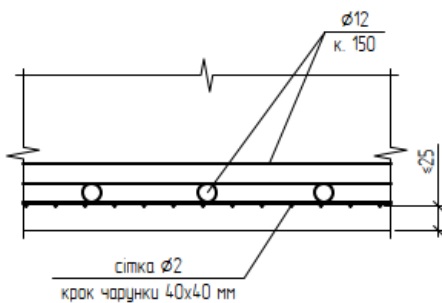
Розрізи армованих стін та перекриттів
